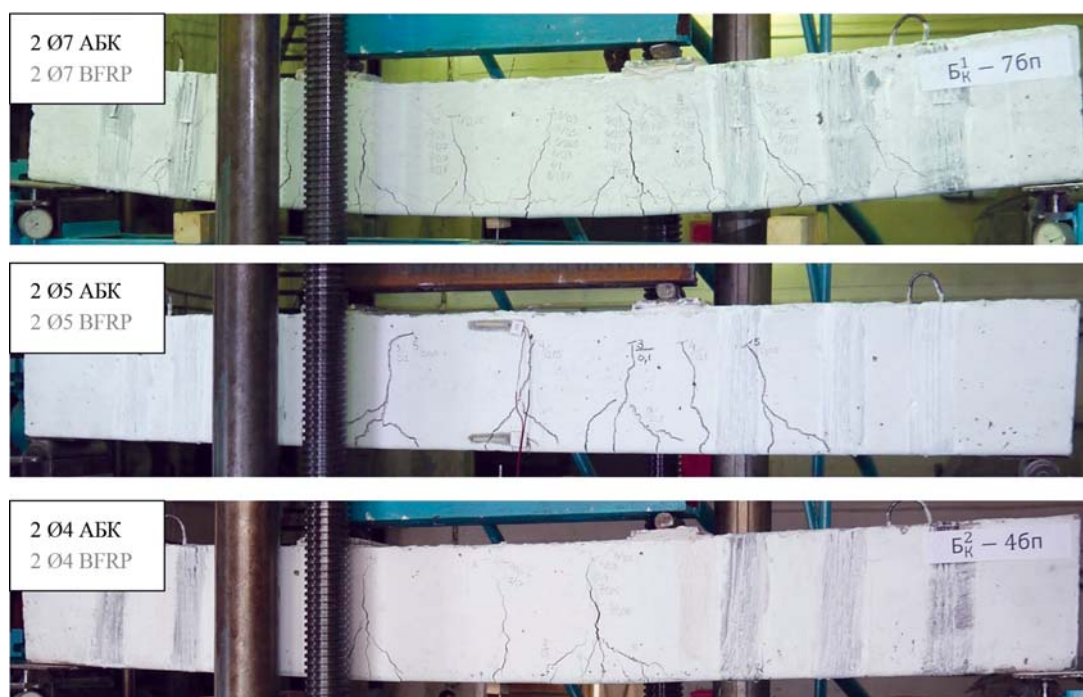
Характер трещинообразования у балок третьей серии, армированных с 2 Ø7 АБК, 2 Ø5 АБК и 2 Ø4 АБК
